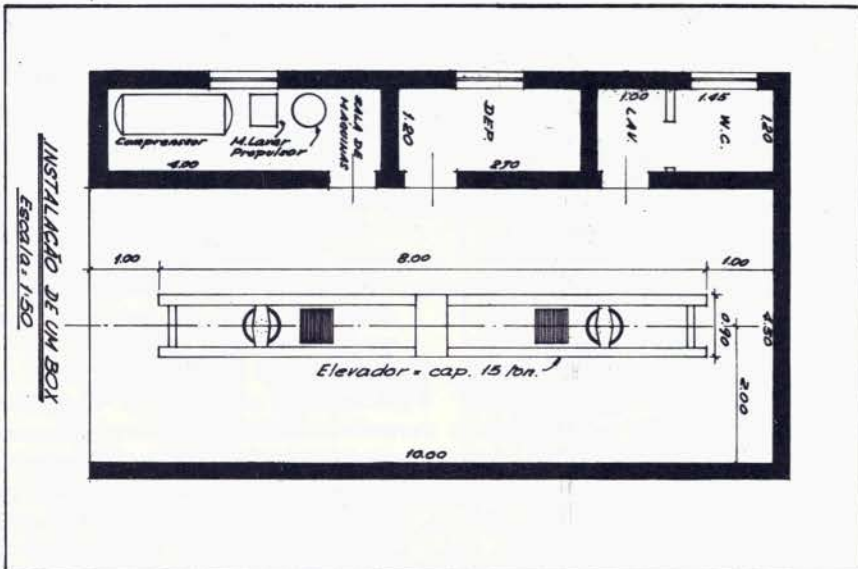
Planta de instalação de um box, compreendendo elevador de dois pistões, sala de máquinas e depósito de materiais; elementos essenciais do posto próprio.
